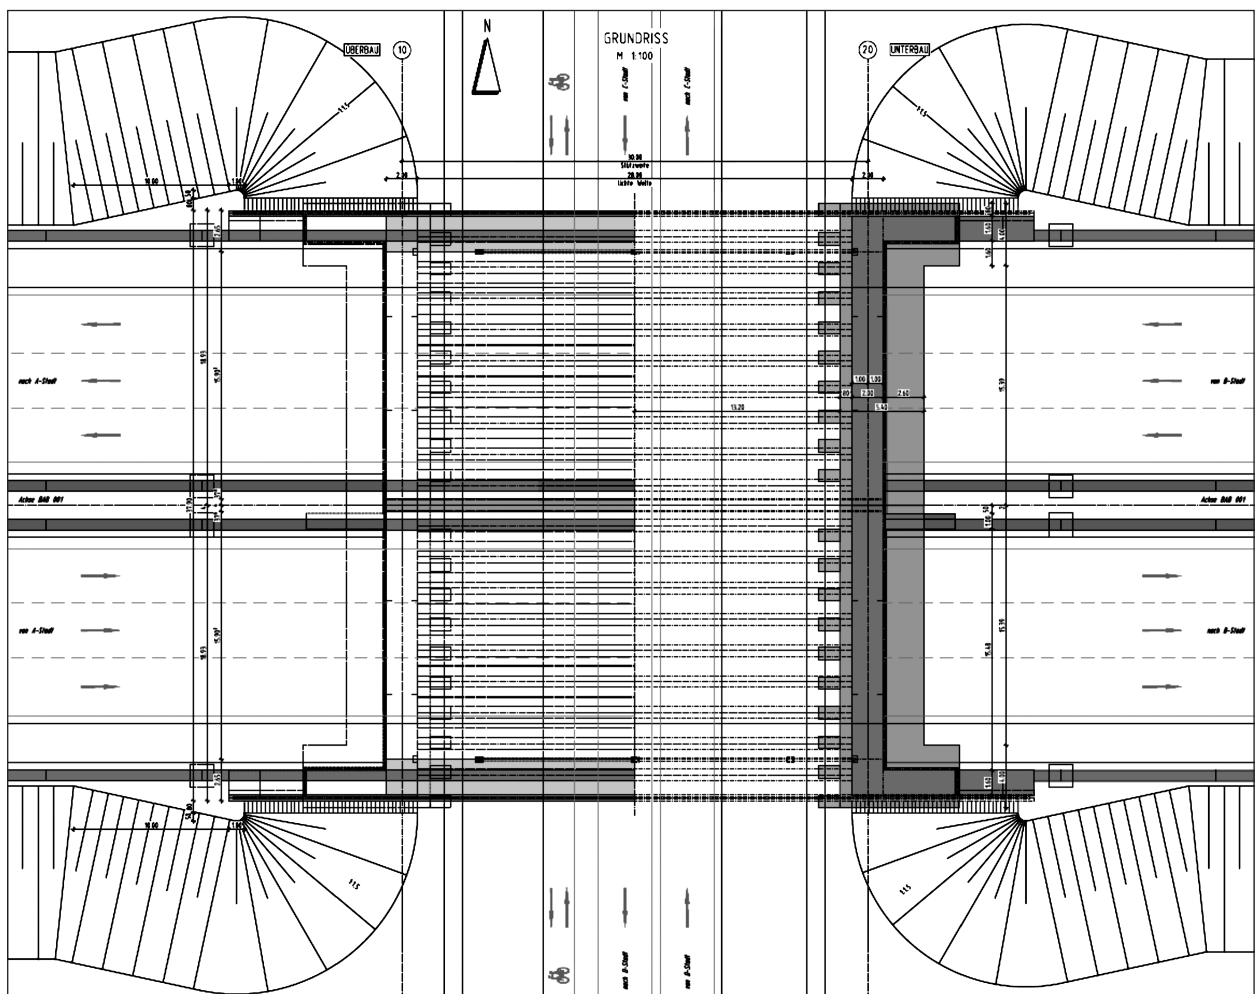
Grundriss Überbau und Unterbau Bauwerk 1
